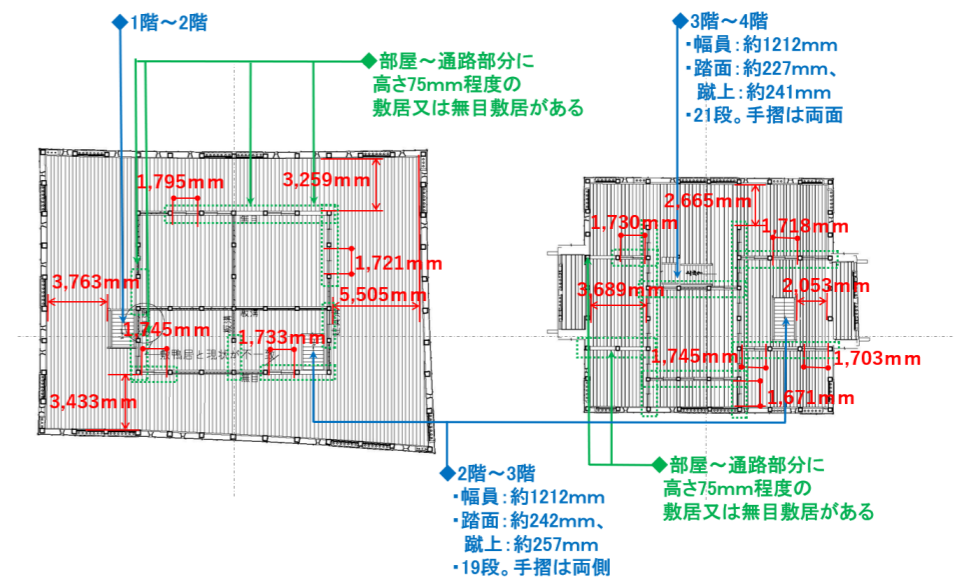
天守 2 階平面図及び天守 3 階平面図（復元原案）
